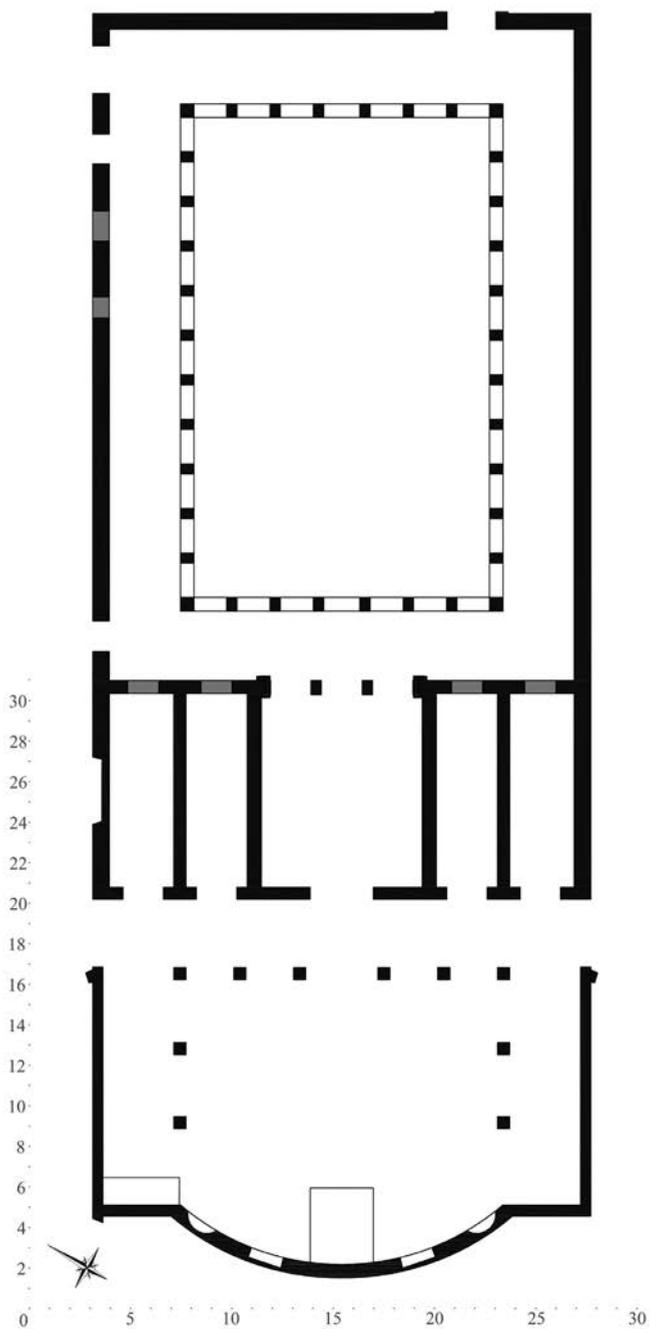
Villa Adriana, cd. Sala dei Pilastri dorici, pianta (autore).
